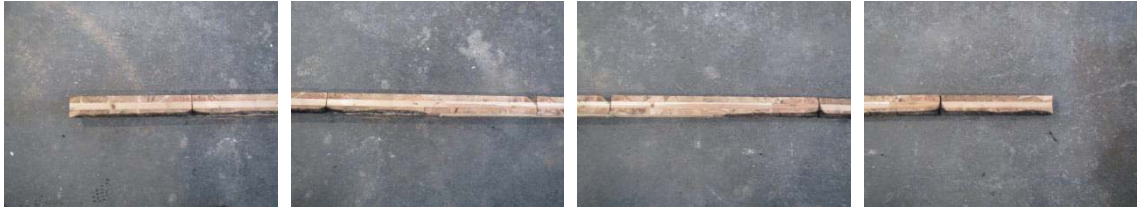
試験後の断面状況（断面Ⅰ）
